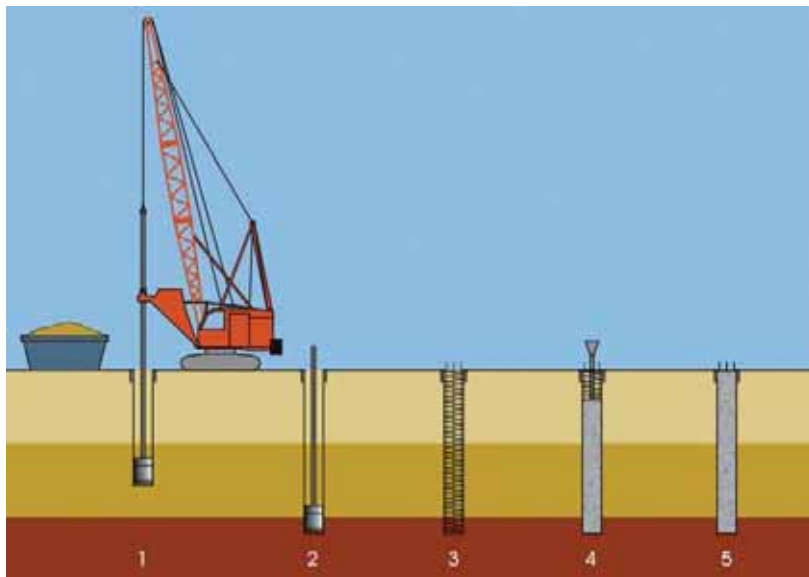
Pilote in situ ejecutado con rotación y lodos.
